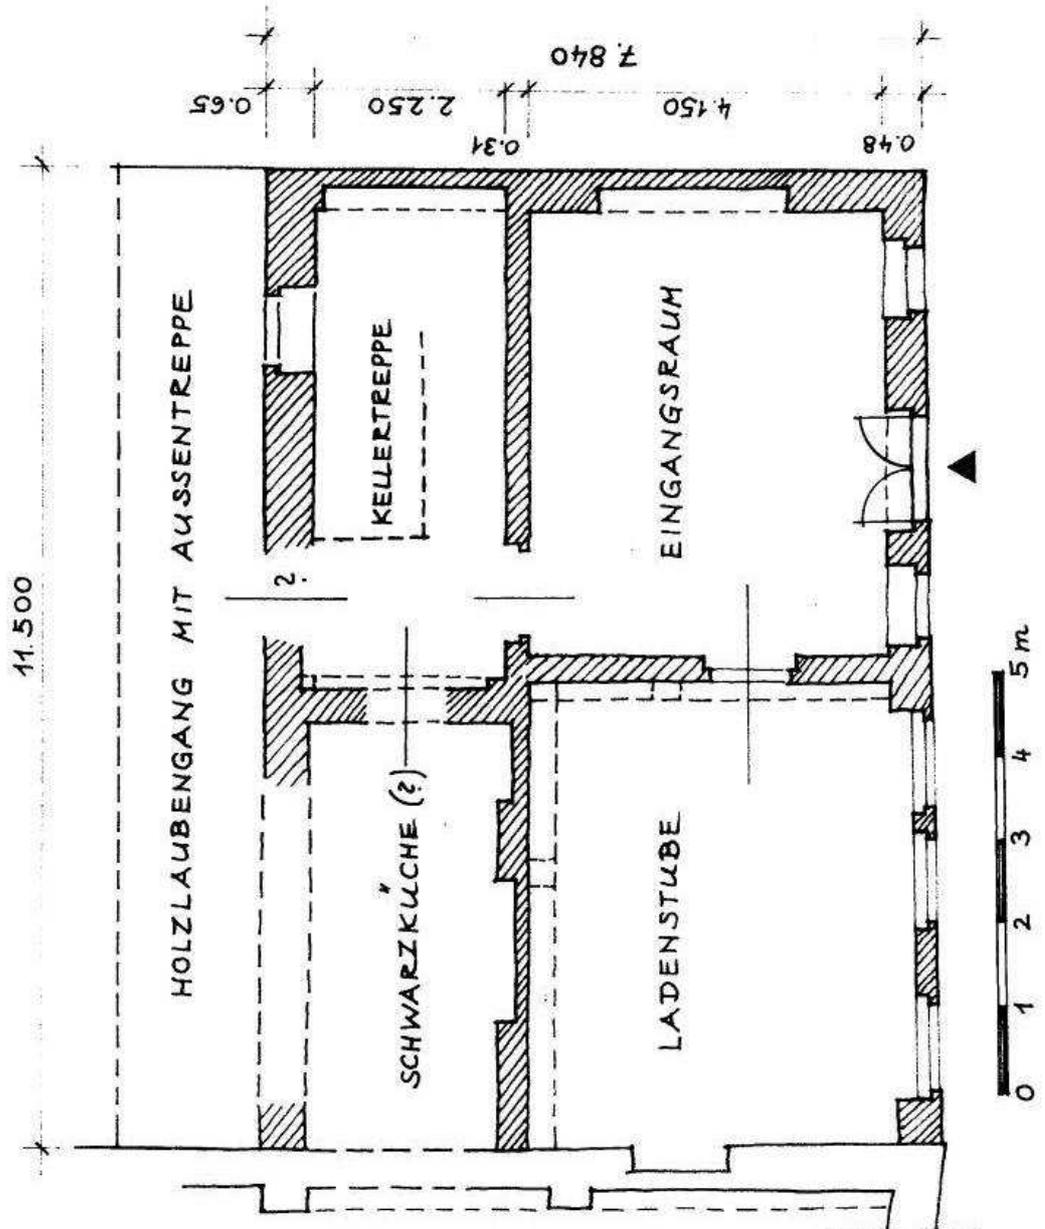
Görnische Gasse 8, Grundriss Erdgeschoss
